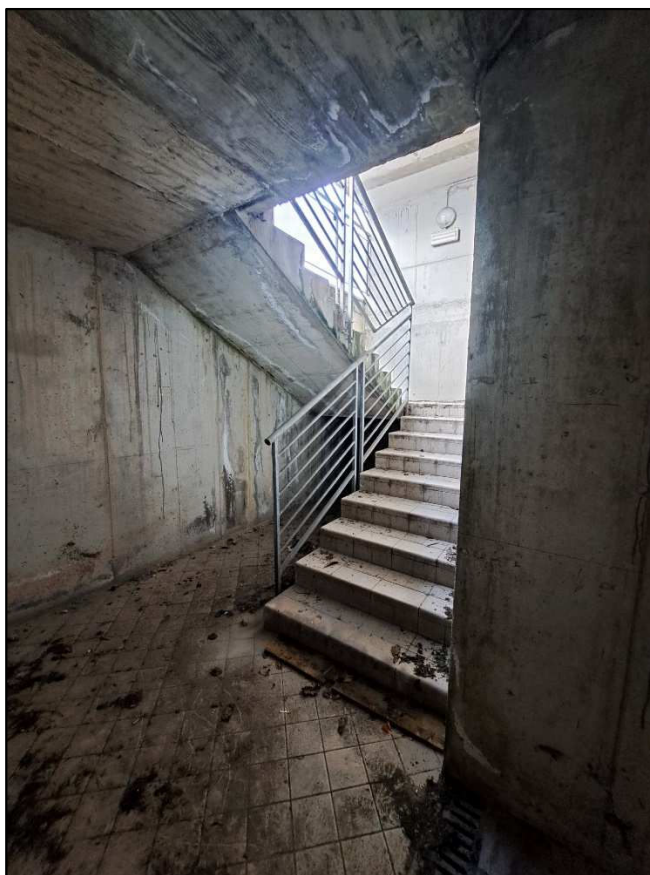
scala ovest di collegamento fra il piano sottostrada e il cortile ovest.
